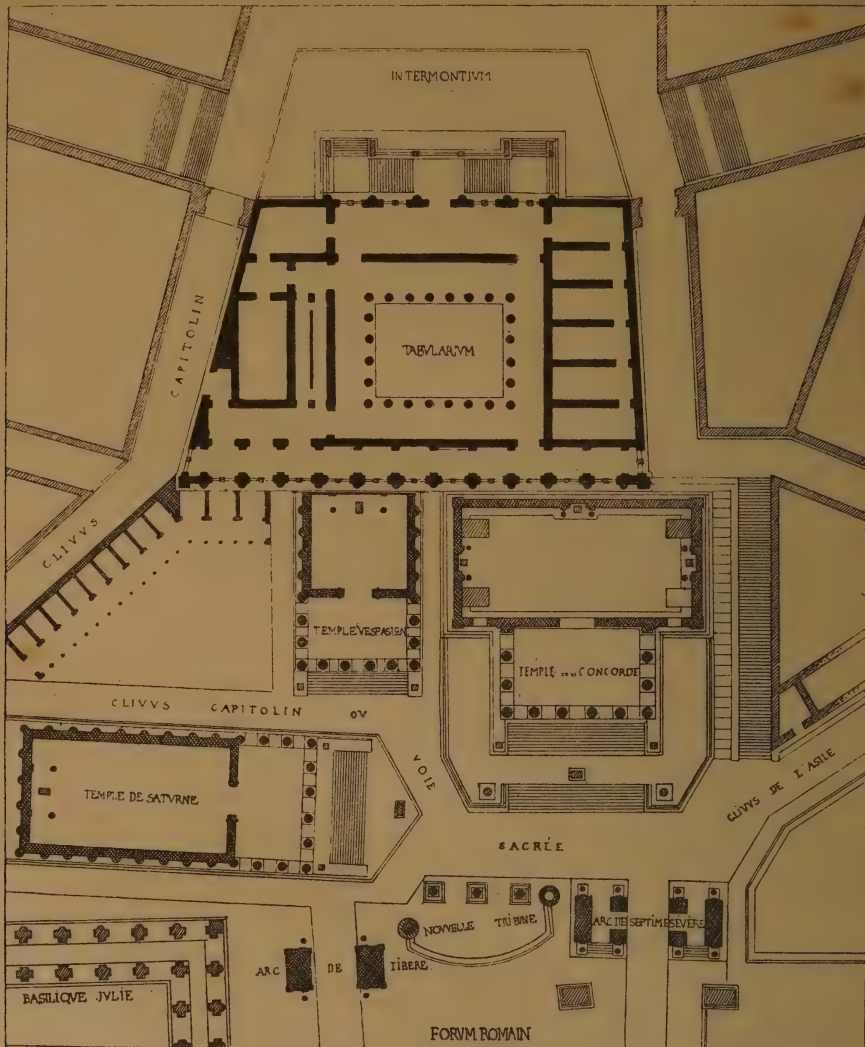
Plan du mont Capitolin : Restauration de M. Moyaux.
